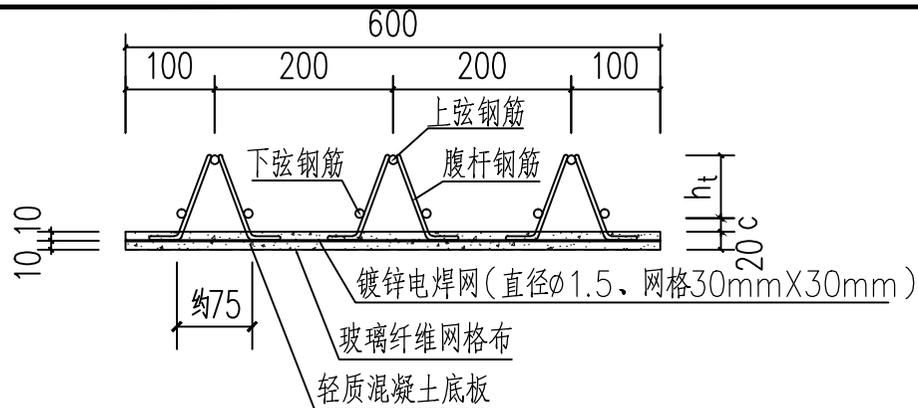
MC板剖面构造示意图(600mm宽标准板)
